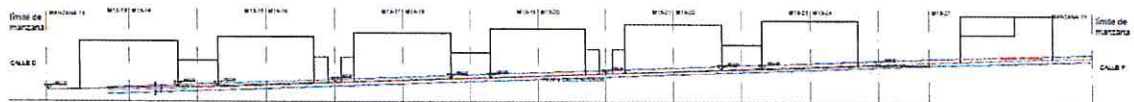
Sección Calle Central. Fuente: Elaboración propia.
